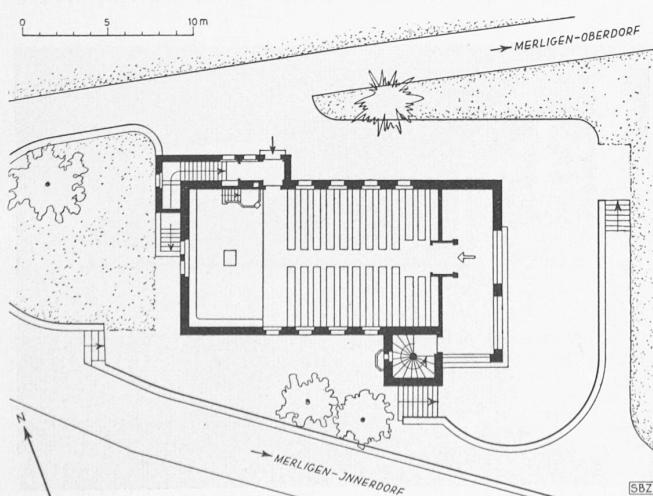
Grundriss mit Umgebung der Kirche Merligen, 1:400
